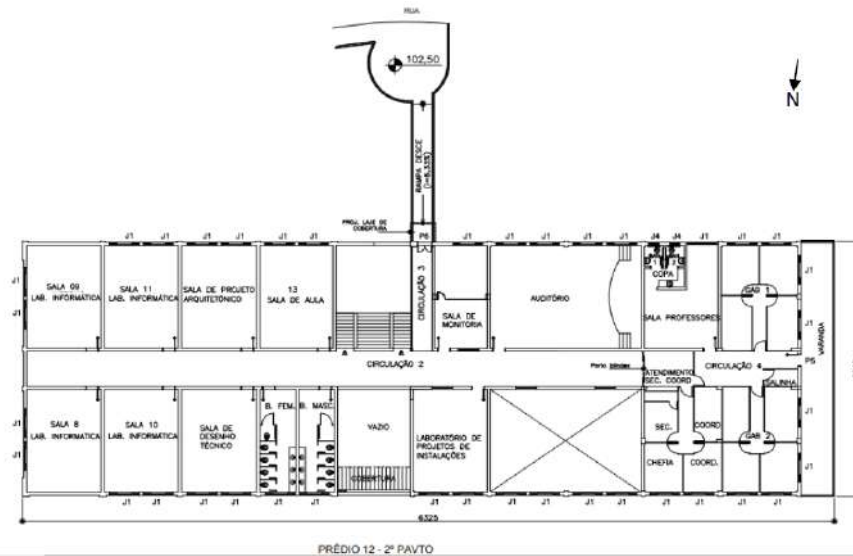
Planta baixa 2º pavimento prédio 12. Fonte: Adaptado de CEFET-MG, [201-].
